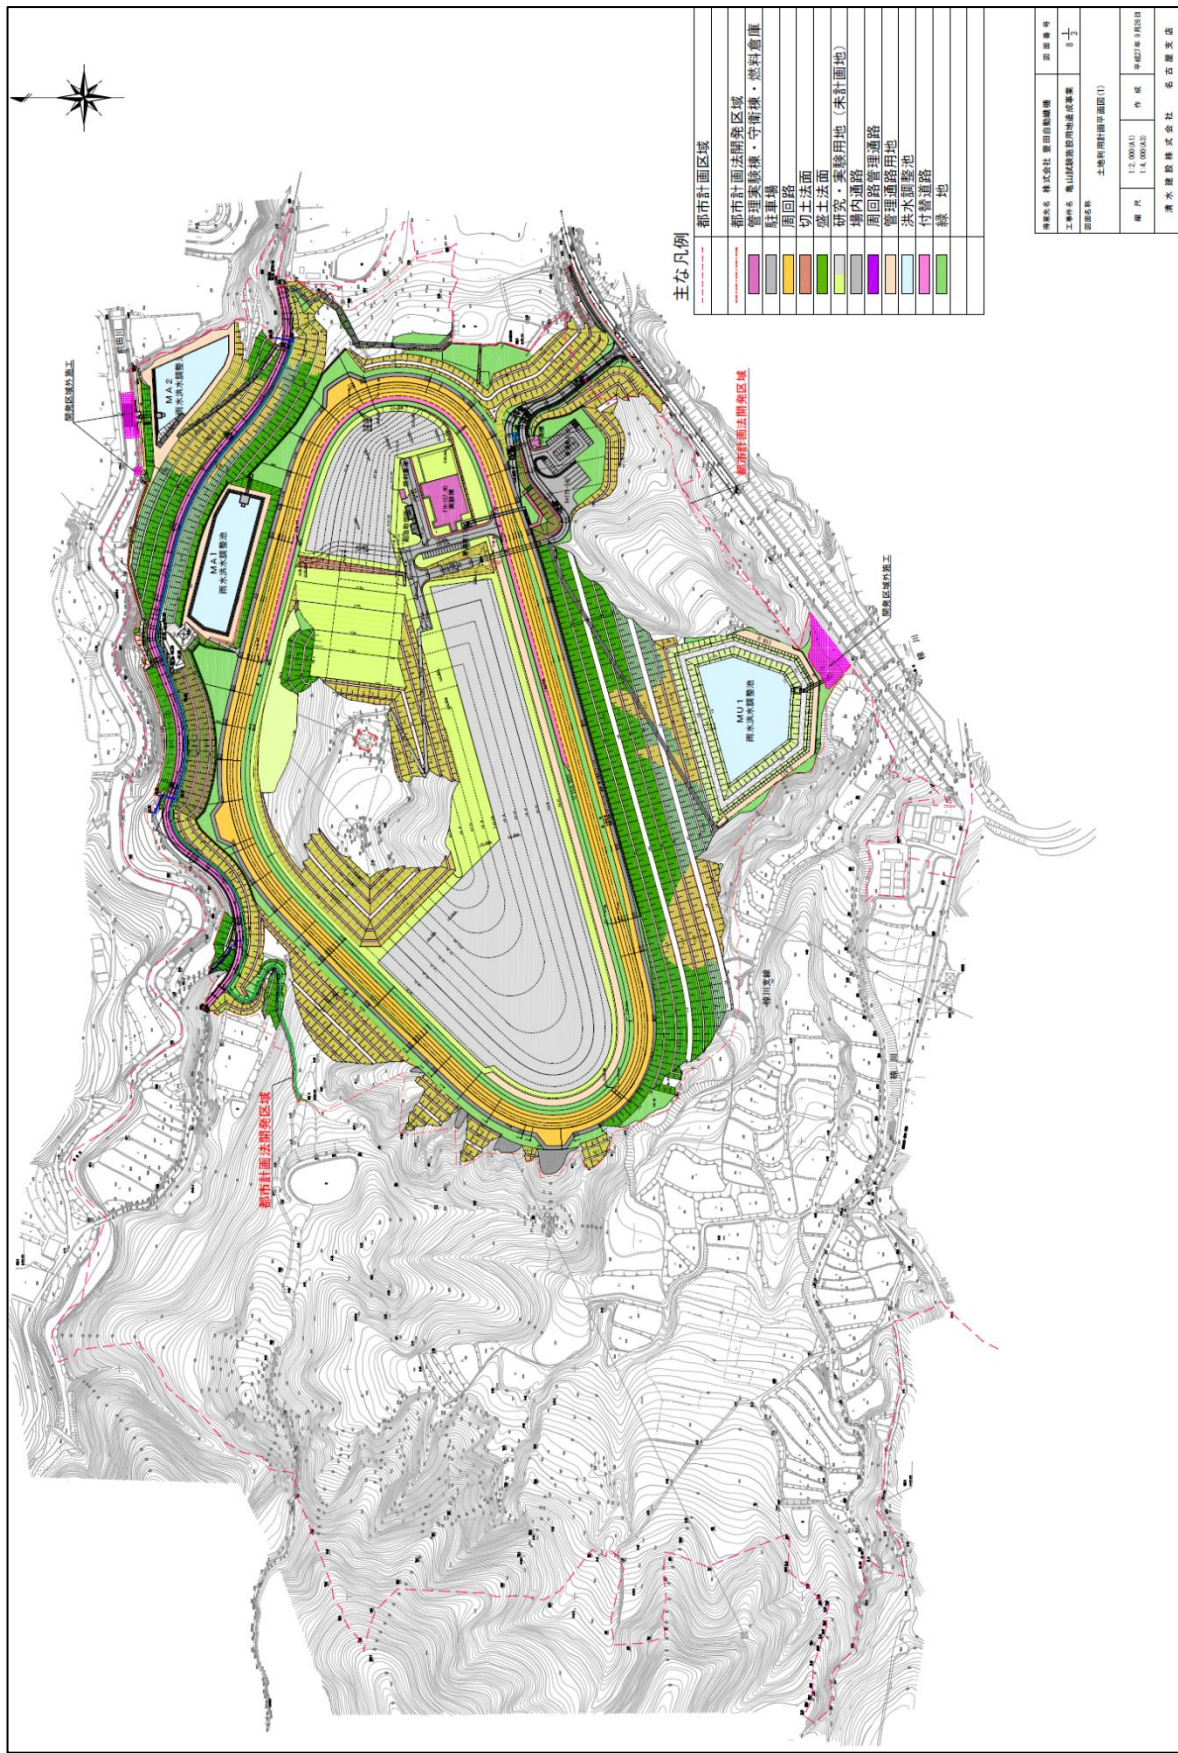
土地利用計画平面図 (第 2 回変更)
